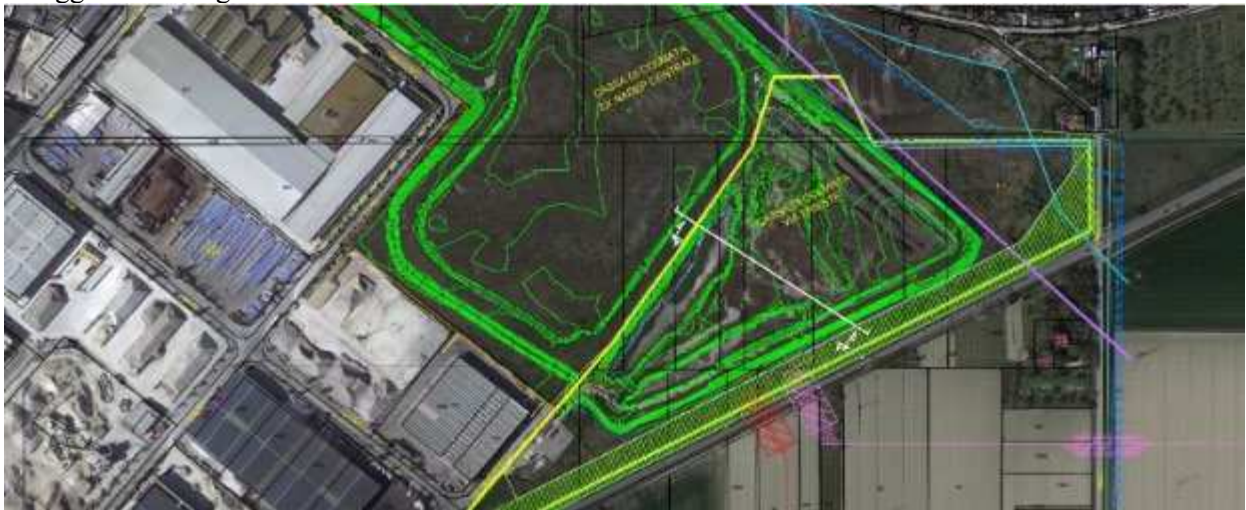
Planimetrico dell'area Agnes Ravenna Porto
